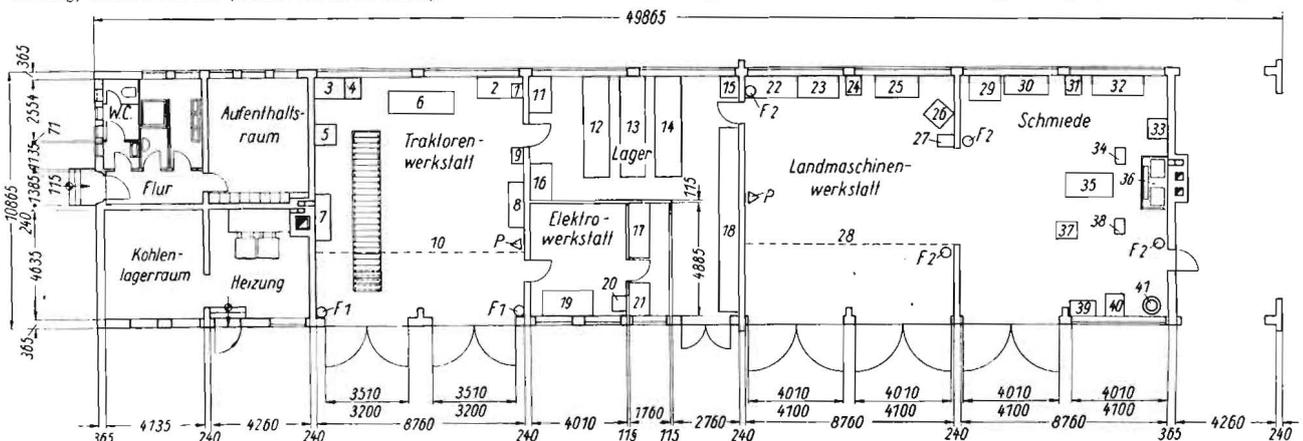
Grundriß der Hauptwerkstätten mit Standorten für die Maschinen und Einrichtungen.
